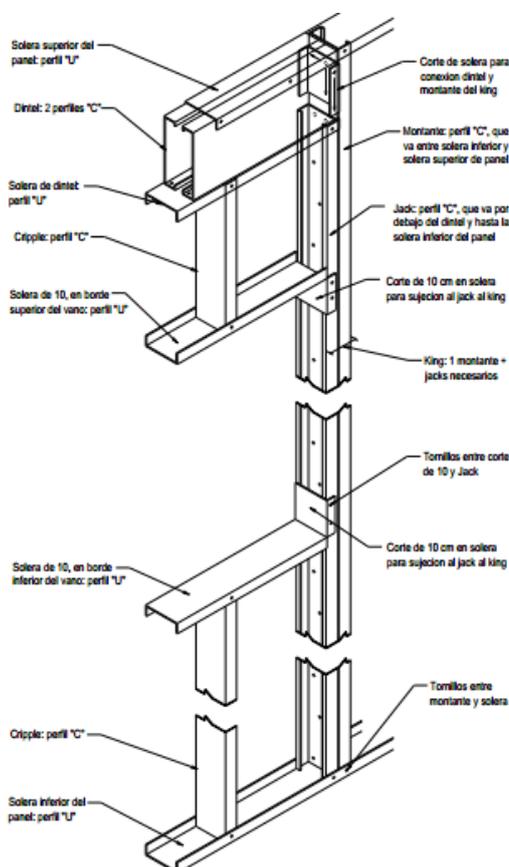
Detalle de construcción de un vano en un sistema Steel Frame (ConsulSteel, 2013)
